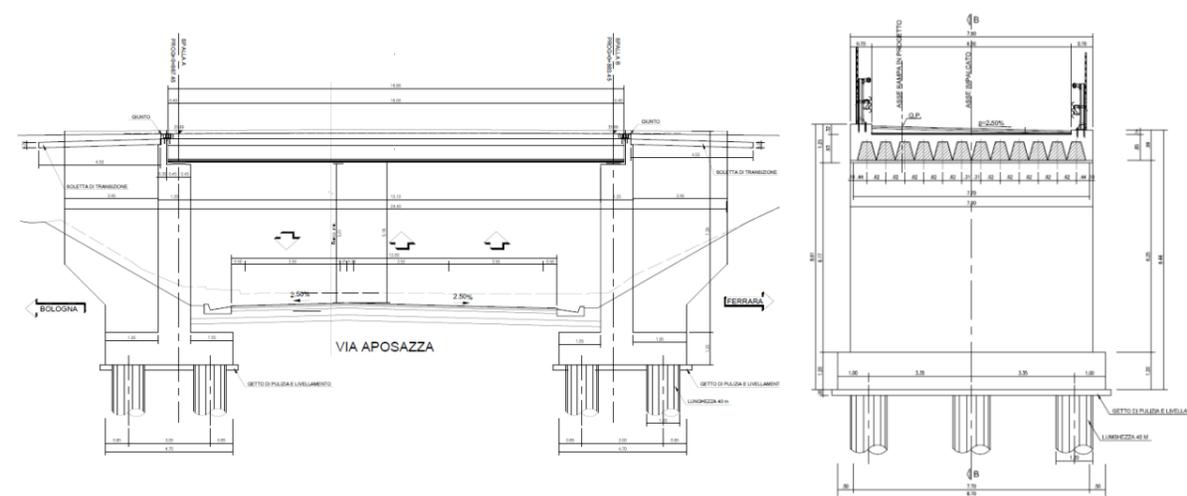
Sinistra la sezione trasversale, a destra sezione longitudinale del sottovia
